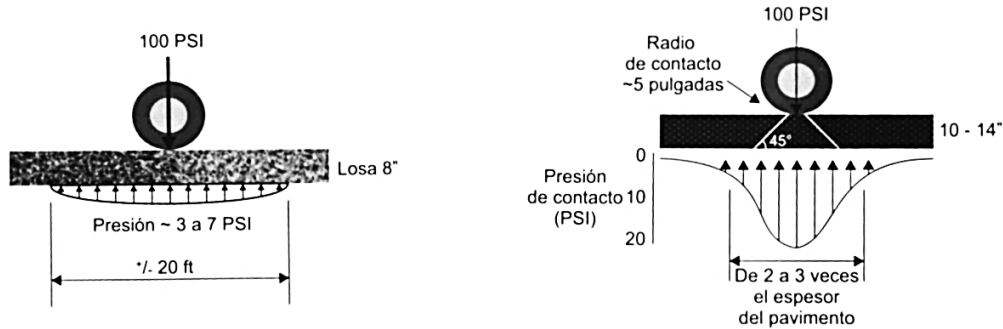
Ejemplo de la distribución de las cargas a nivel de subbase en un pavimento de concreto (izquierda) y un pavimento flexible (derecha)
